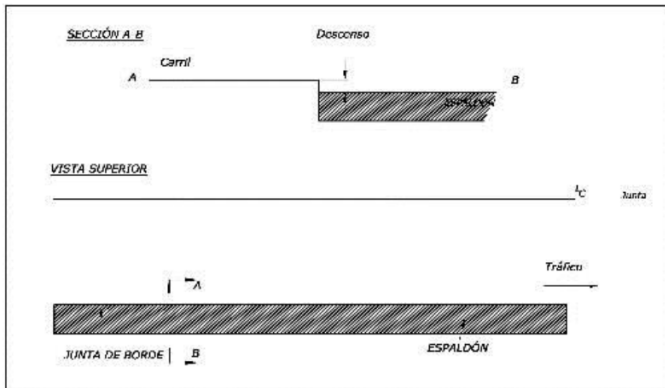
Esquema Escalonamiento entre Calzada y Espaldón - Pavimento Rígido
